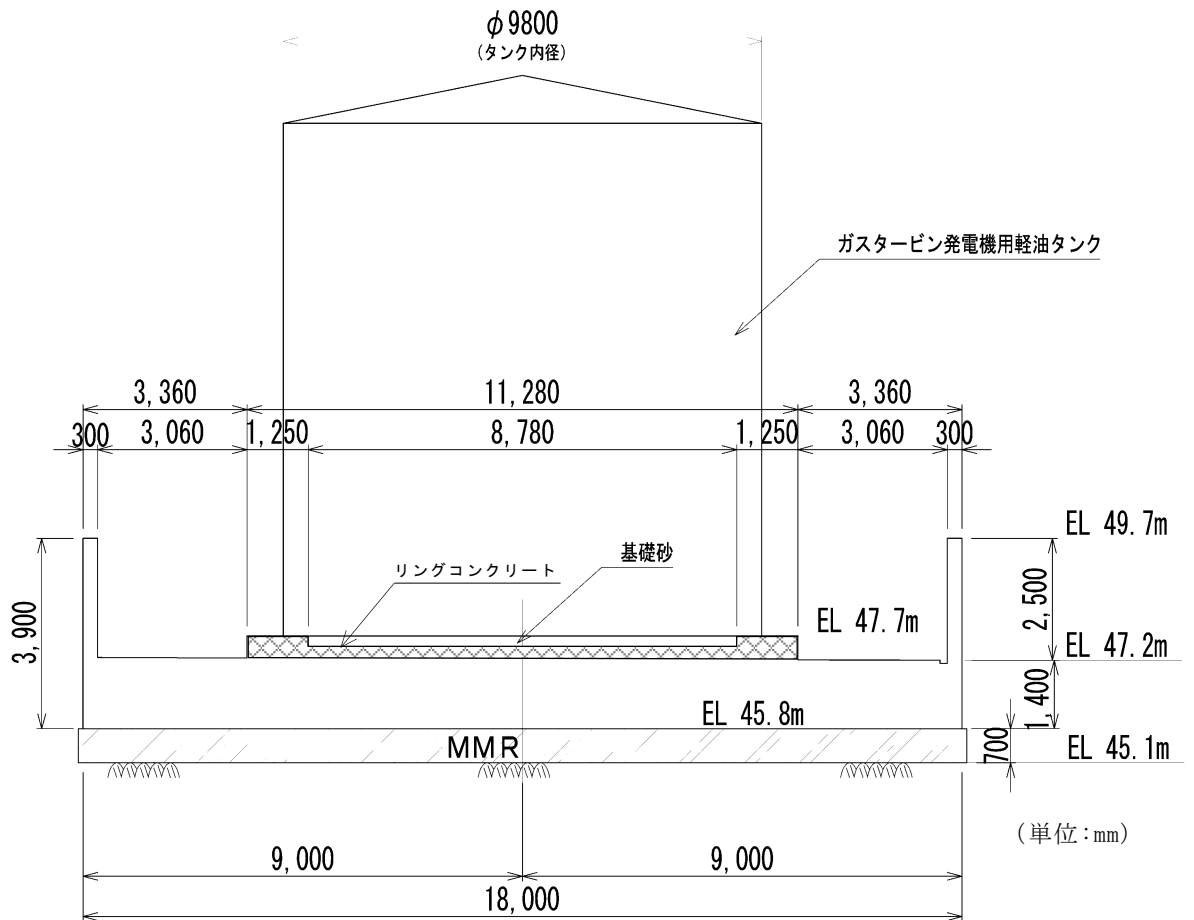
ガスタービン発電機用軽油タンク基礎 断面図 (A-A断面及びB-B断面)
